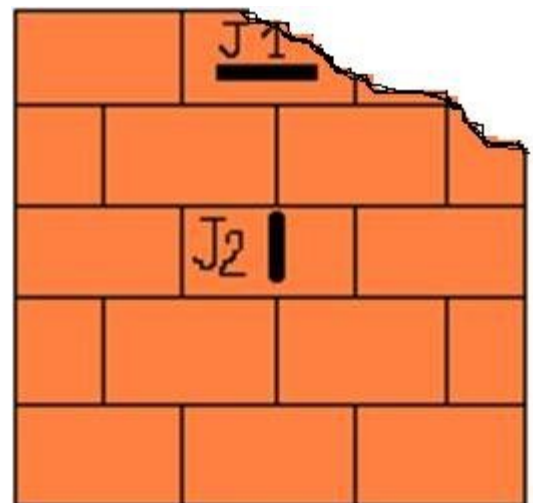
Rupture mur 12 trous de l'essai n°9.
